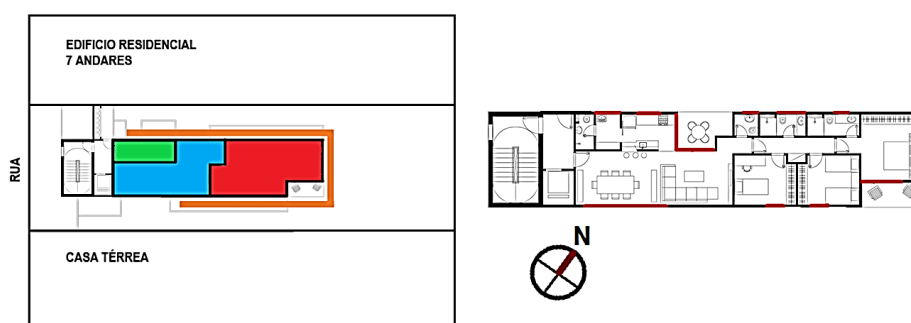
Ed. Montevideo 258, pavimento tipo com uma unidade por pavimento.
